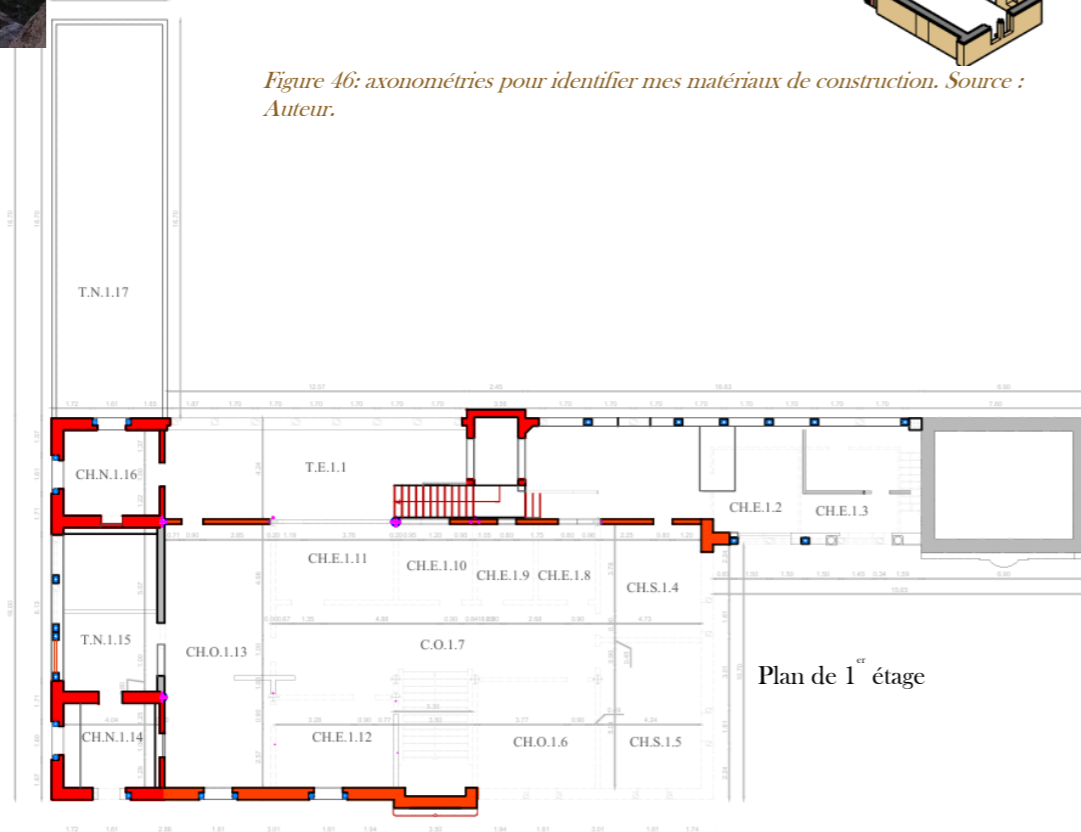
plan d'identification des matériaux de construction en 1er étage. Source : Auteur.
